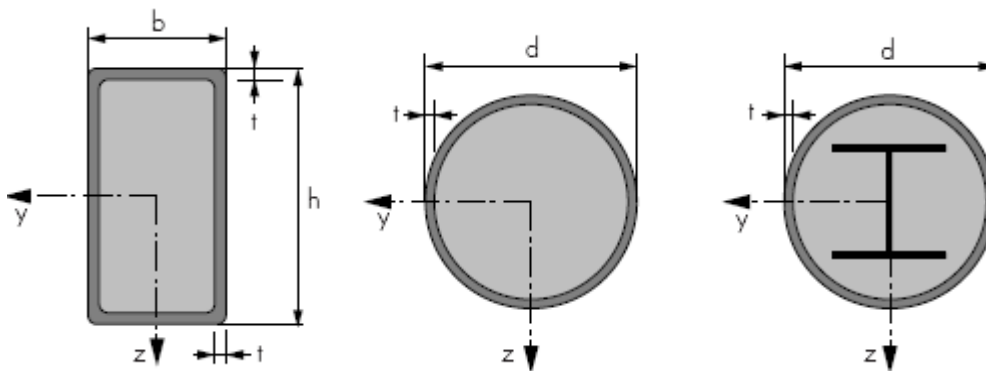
Exemple de colonnes mixtes remplies de béton
